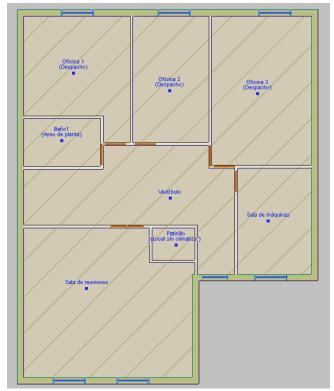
Distribución de planta baja de edificio de oficinas.
